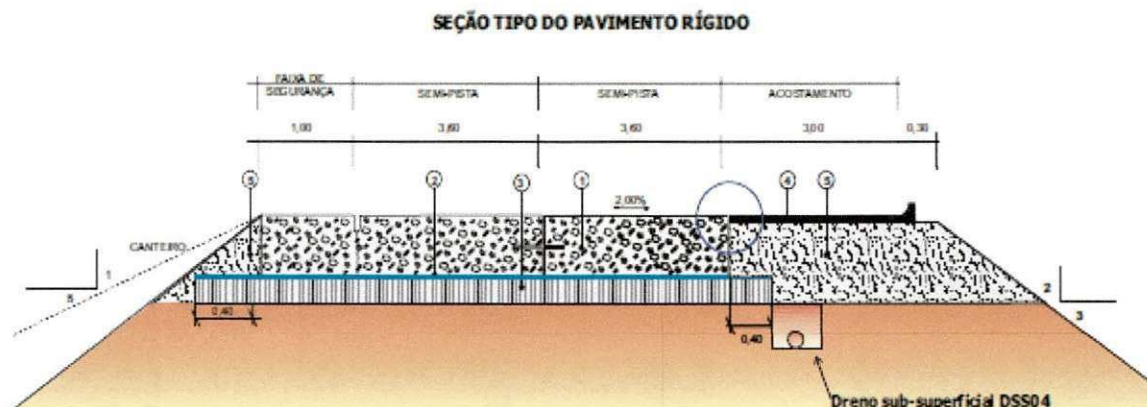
Seção tipo do pavimento rígido da BR101- Lote 05
